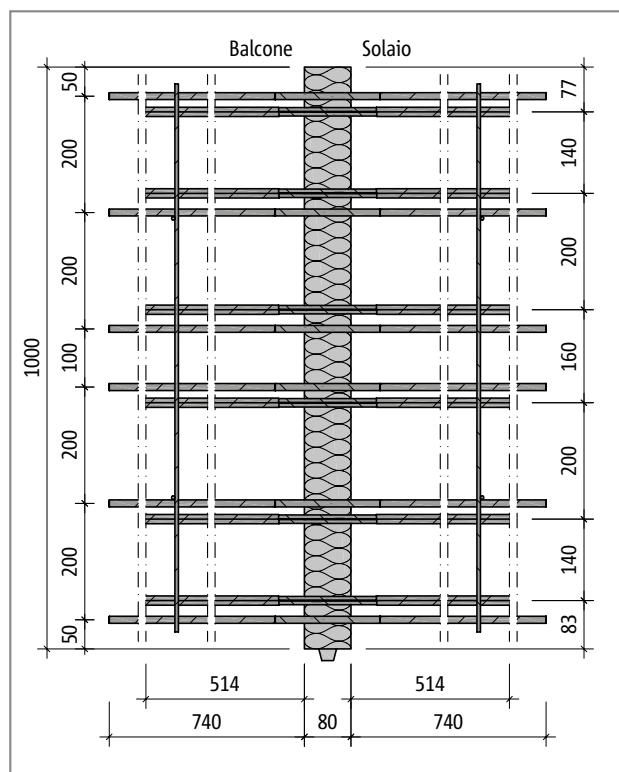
Schöck Isokorb® tipo D20M, pianta del prodotto
